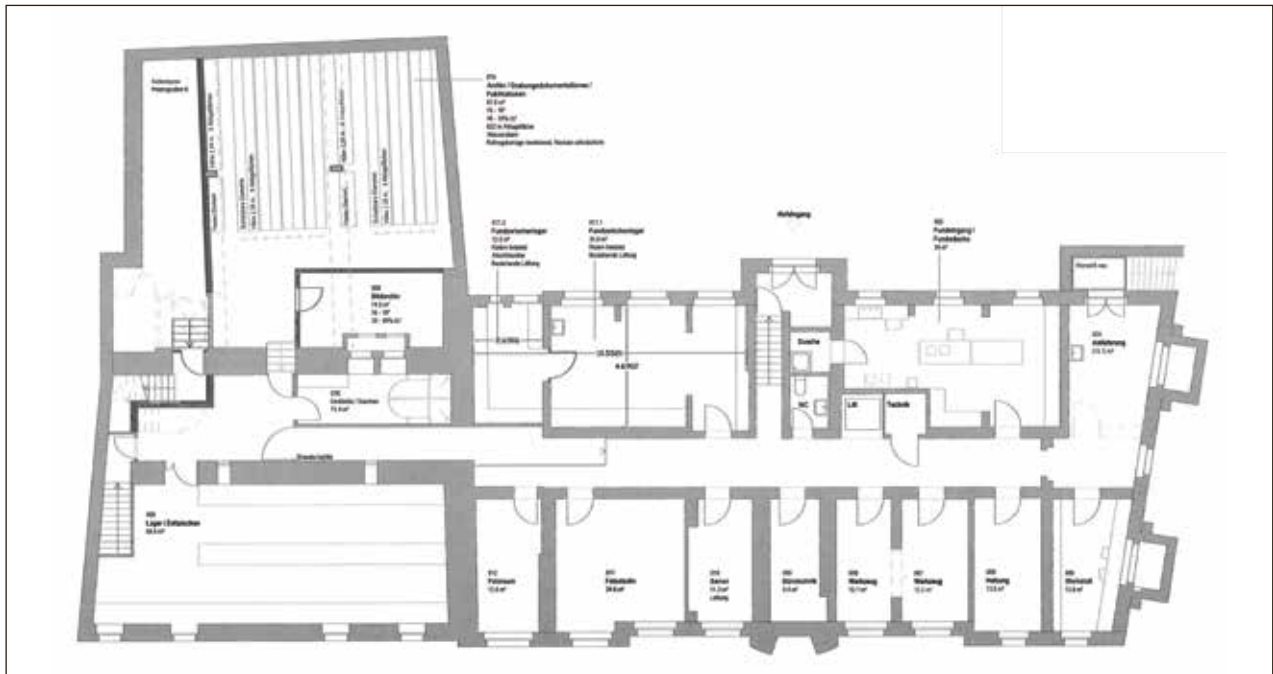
Grundriss des Untergeschosses.
